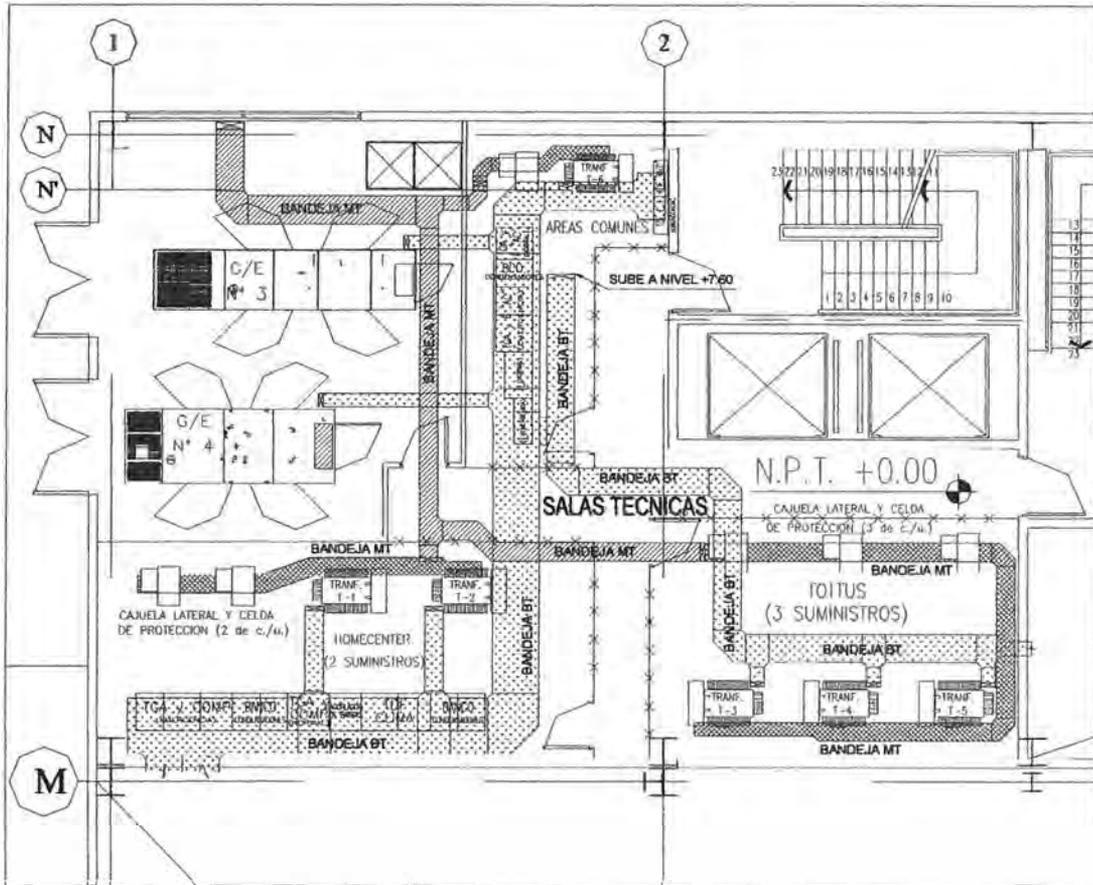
, Vista de planta del cuarto técnico, nivel +0.00.
